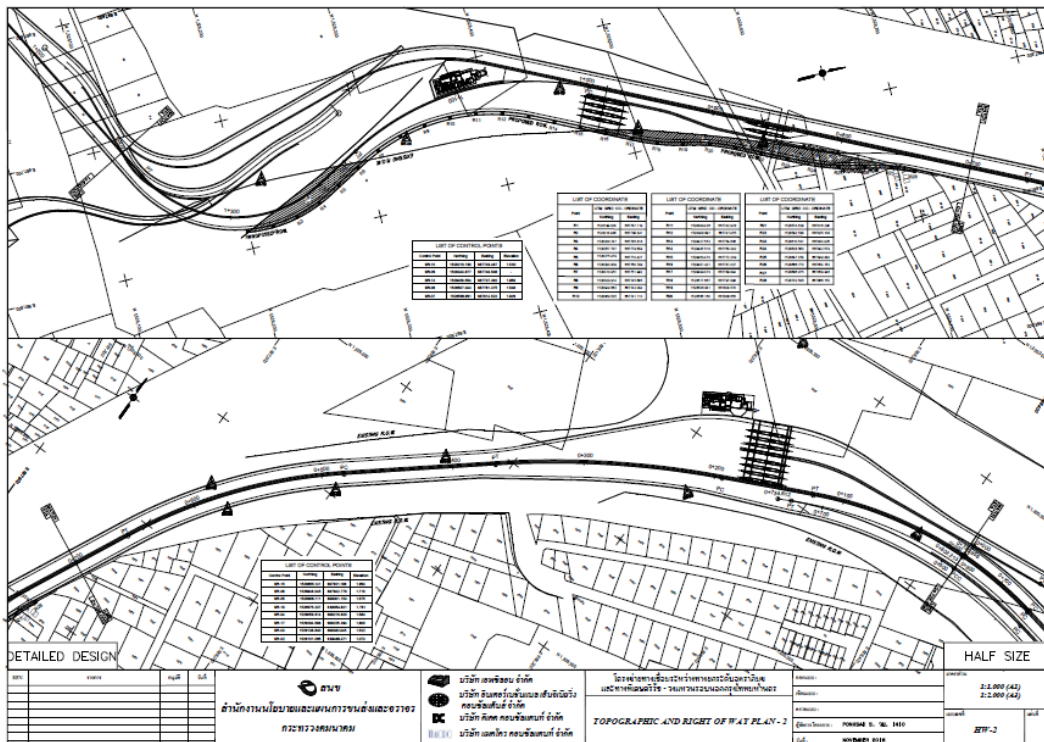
ขั้นตอนการจัดทำ Cadastral Plan
